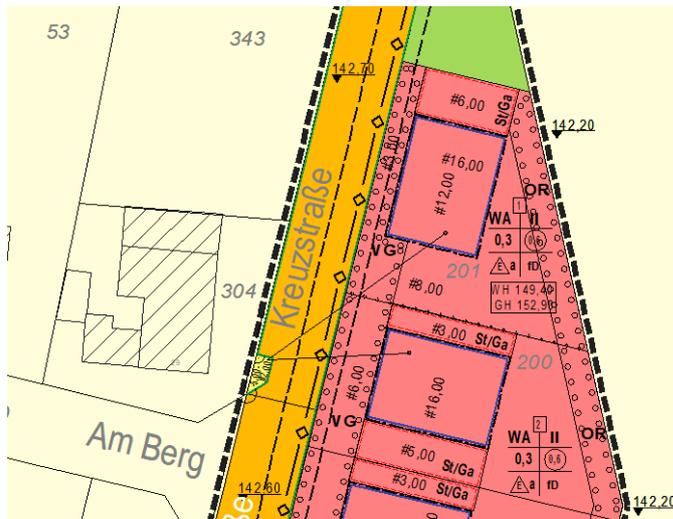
Lageplan Planausschnitt mit der Aufstellfläche als Versorgungsfläche (gelb) und Zuordnung, genordet, ohne Maßstab
